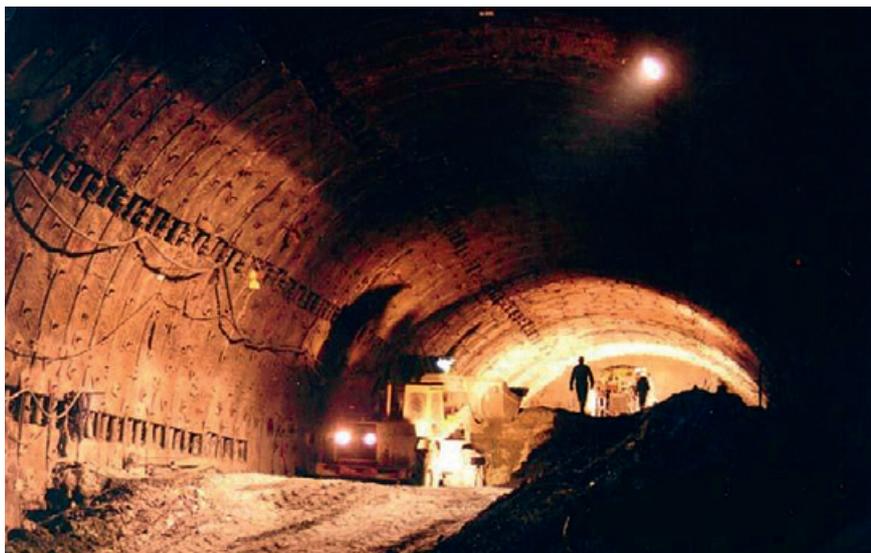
Galgenbergtunnel – Stauchelemente in Verformungsschlitten einer in Segmente unterteilten Spritzbetonschale
